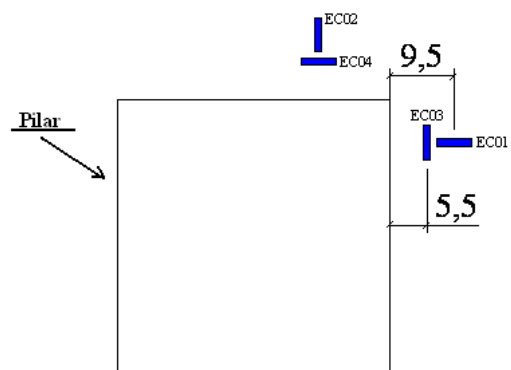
Extensometria no concreto do modelo LR-S
